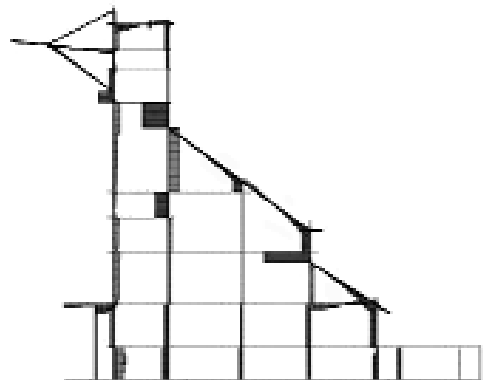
Эпюры поперечных сил в балках и колоннах от расчетной вертикальной нагрузки
